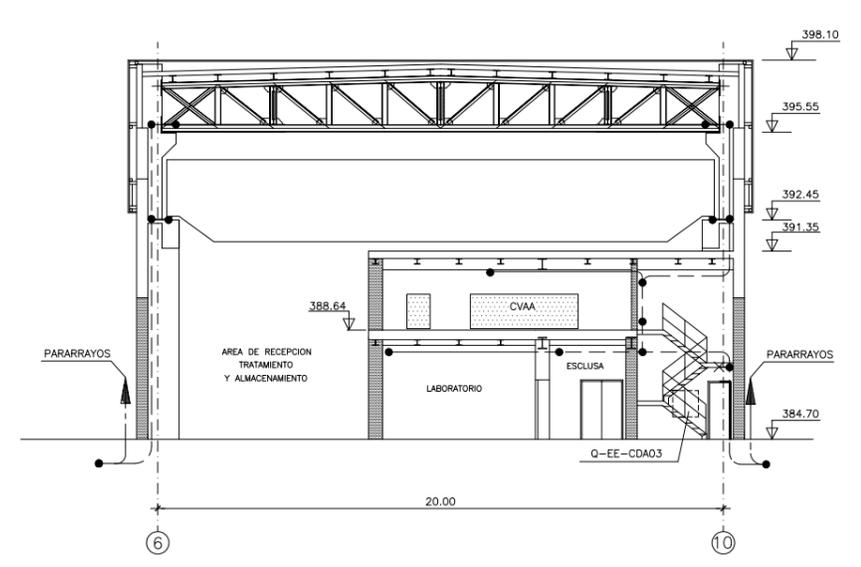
PLANO DE DISPOSICIÓN PENETRACIONES - RMTA.
